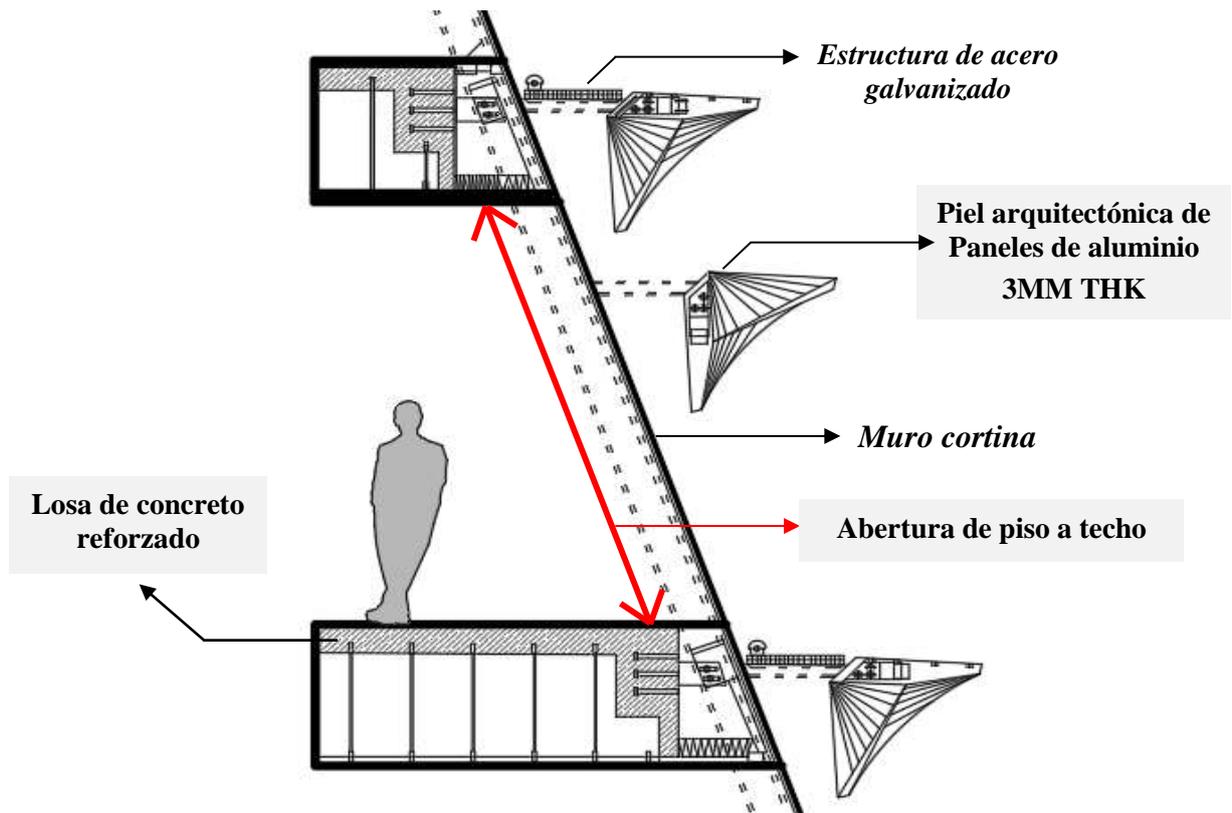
Corte detallado de piel arquitectónica-caso analizado II
